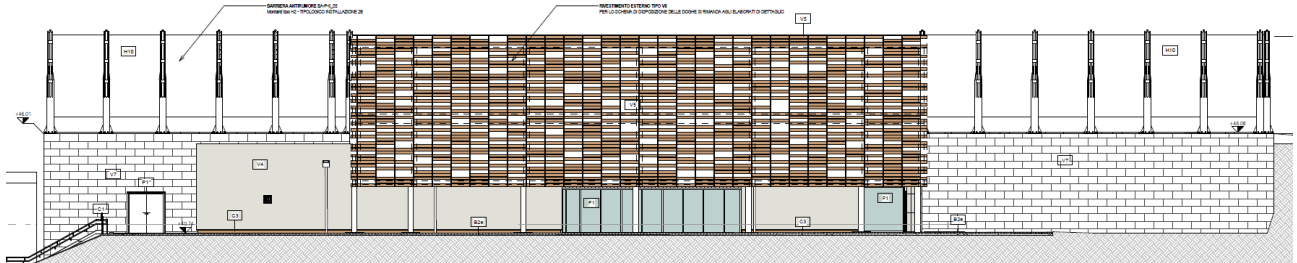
FV05 - Pensilina FV – prospetto lato parcheggio
